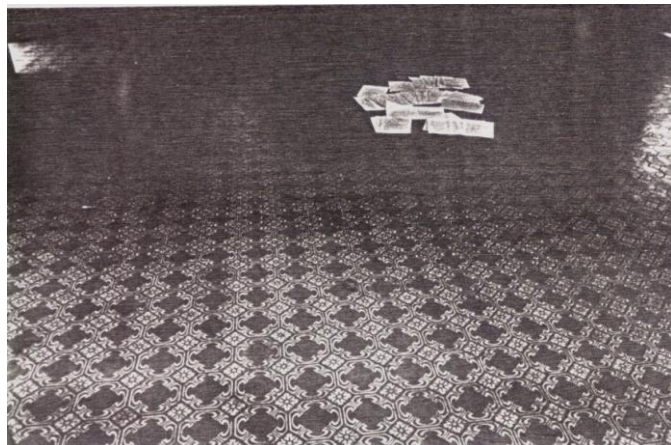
Interior da antiga Estação ferroviária - Trecho do piso em ladrilho hidráulico. Levantamento INEPHAC - 1987.
